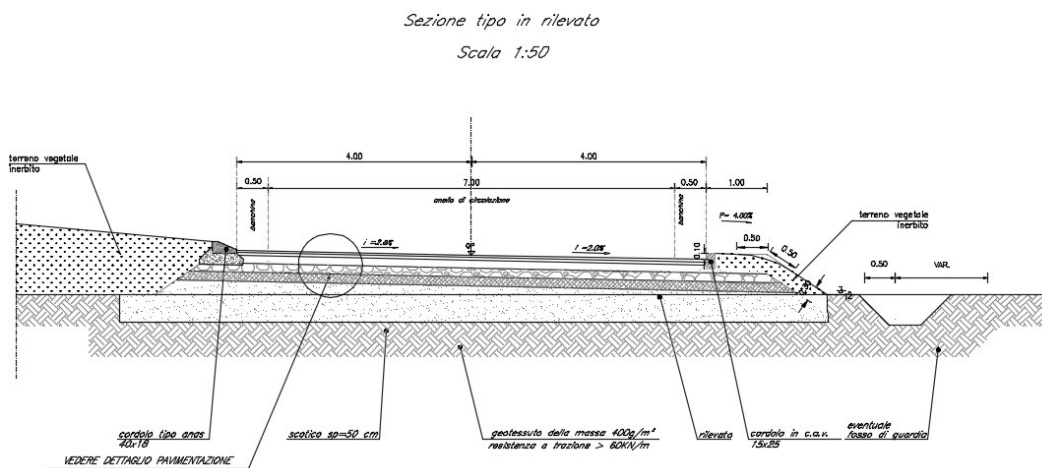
Sezione tipo dell’anello circolatorio della rotonda
